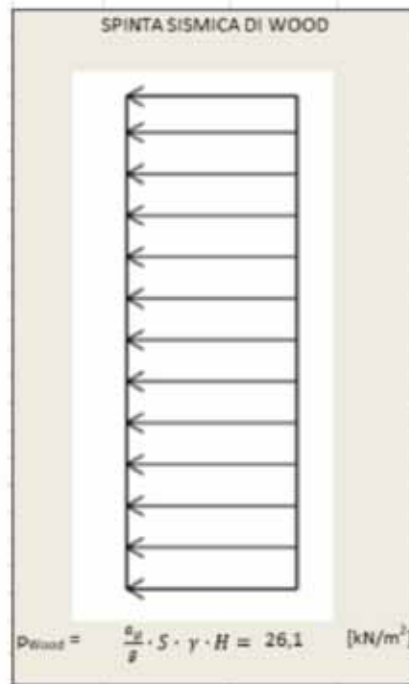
SPALLE A e B – Spinta Sismica Wood
